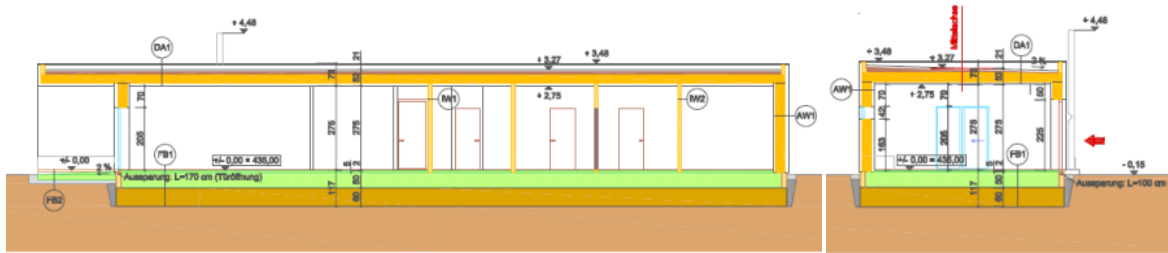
Schnitte Modellgebäude in leichter Bauform (Riegelwände) jedoch mit minimalen Fensterflächen
